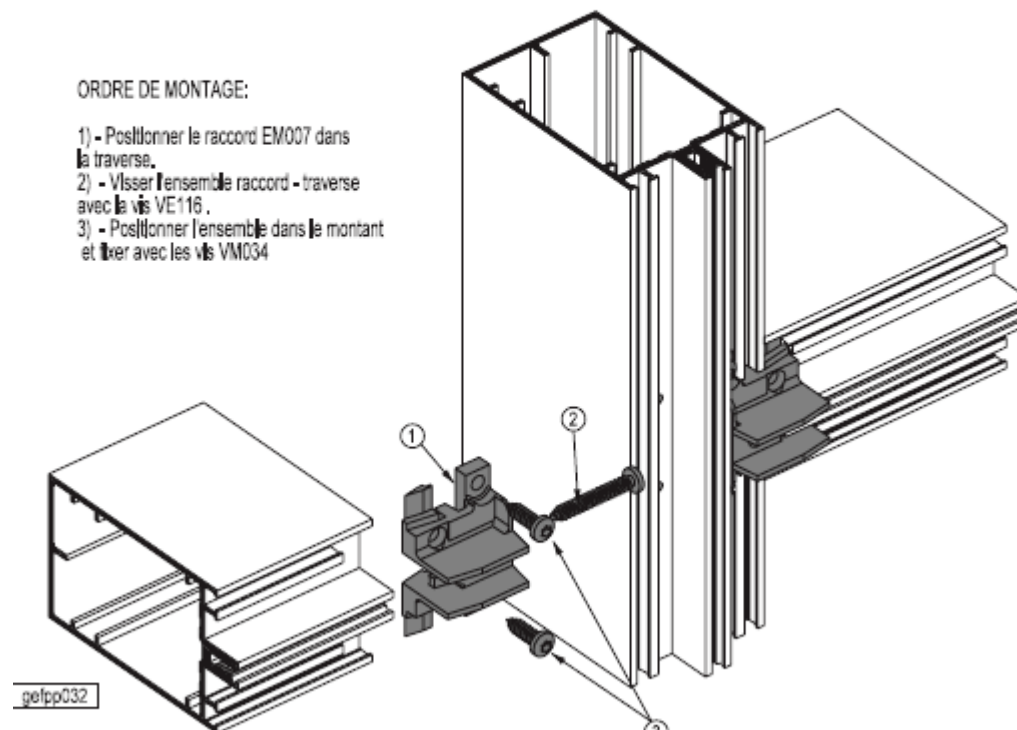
DETAILS D'ASSEMBLAGE ET DE MONTAGE MUR-RIDEAU ASPECT GRILLE-GAMME TECHNAL GEODE MX52
